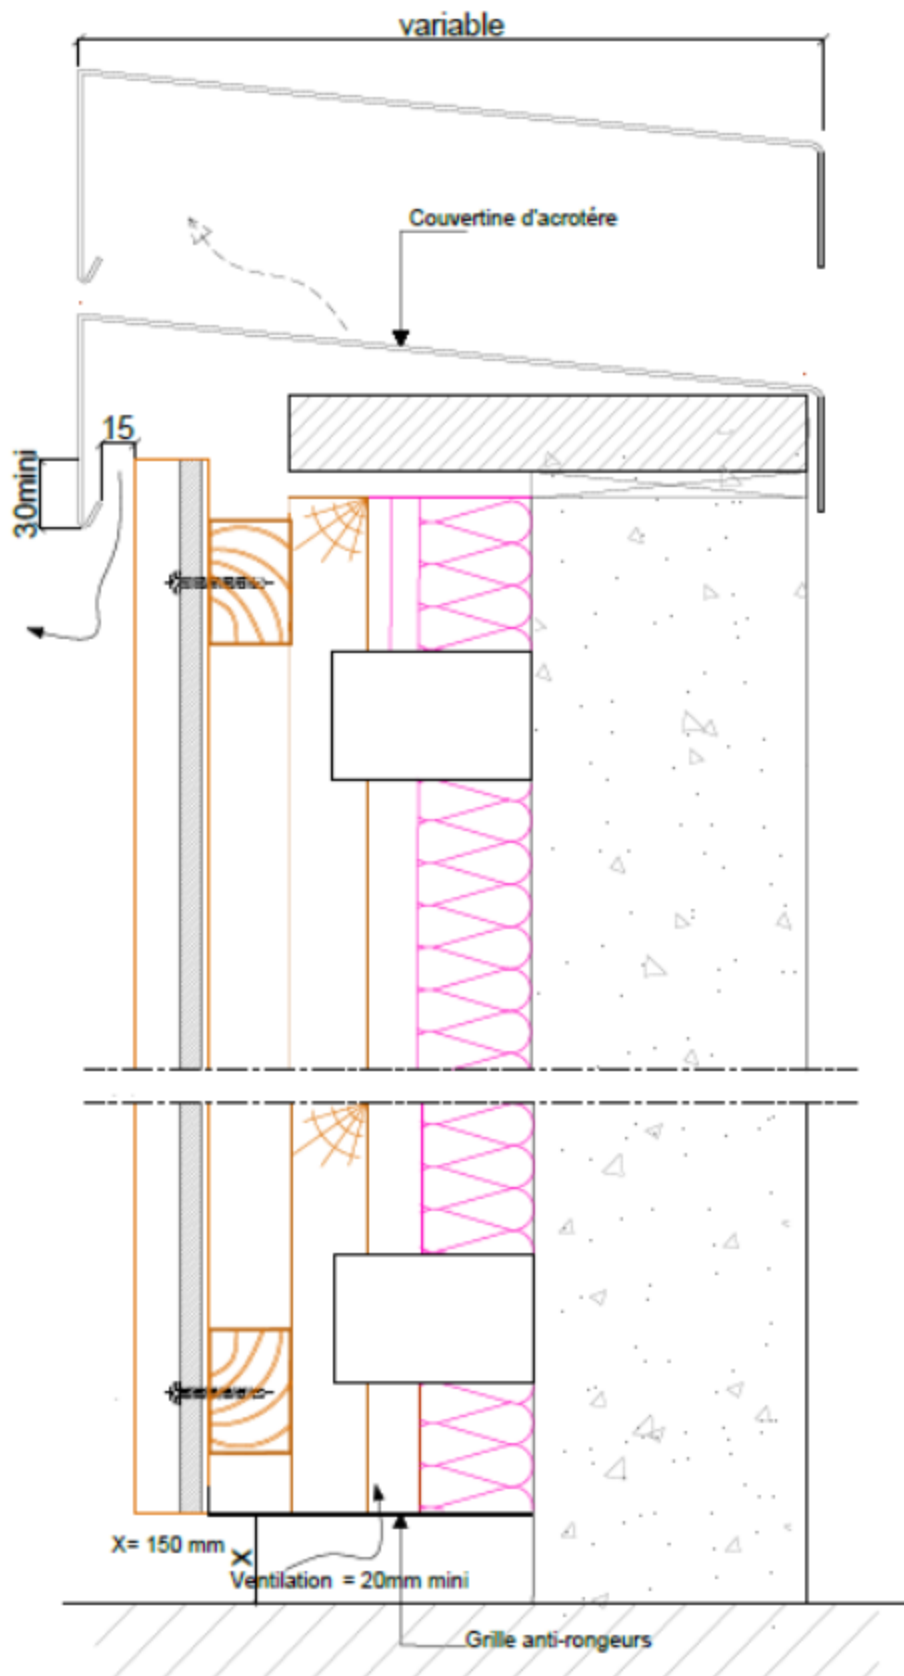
Coupe verticale : départ et arrêt haut bardage sur ossature bois en pose verticale
